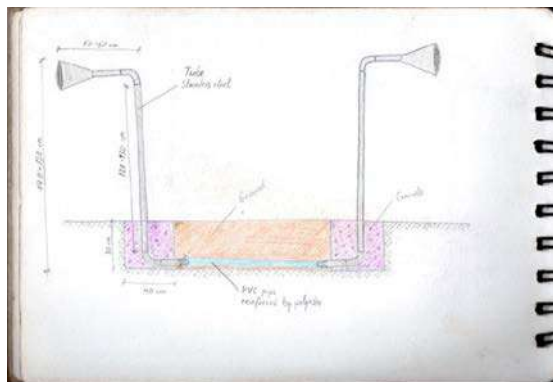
Detalle alzados y cimentación de los teléfonos de tubo. Elaboración propia
